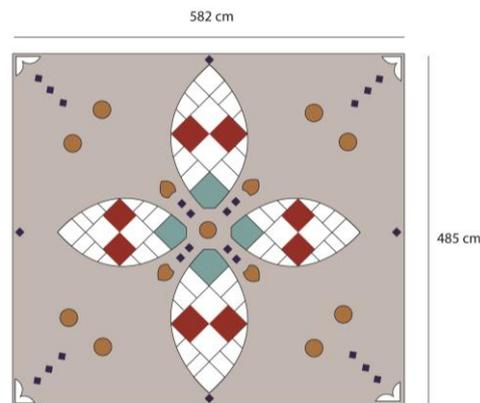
Ruang Transit Beserta Ragam Hias Pada Lantai
